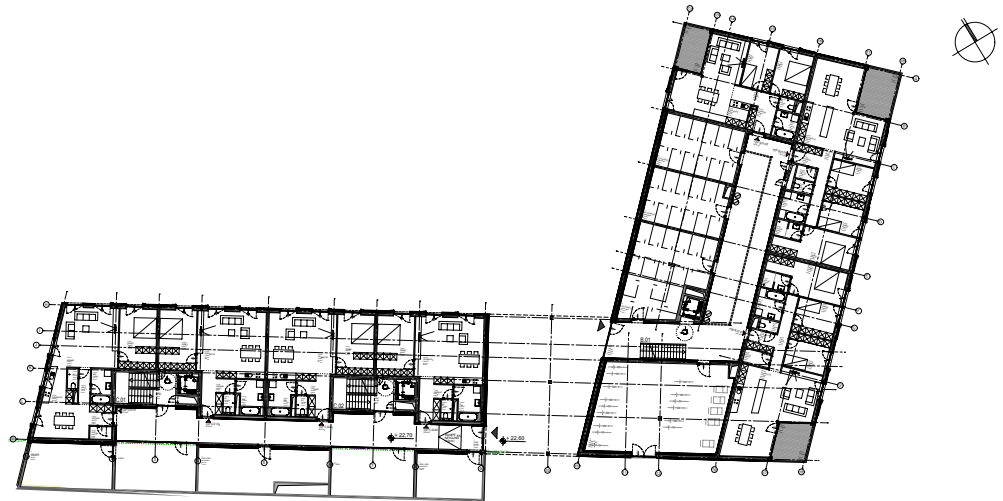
Grundriss Erdgeschoss (76)
